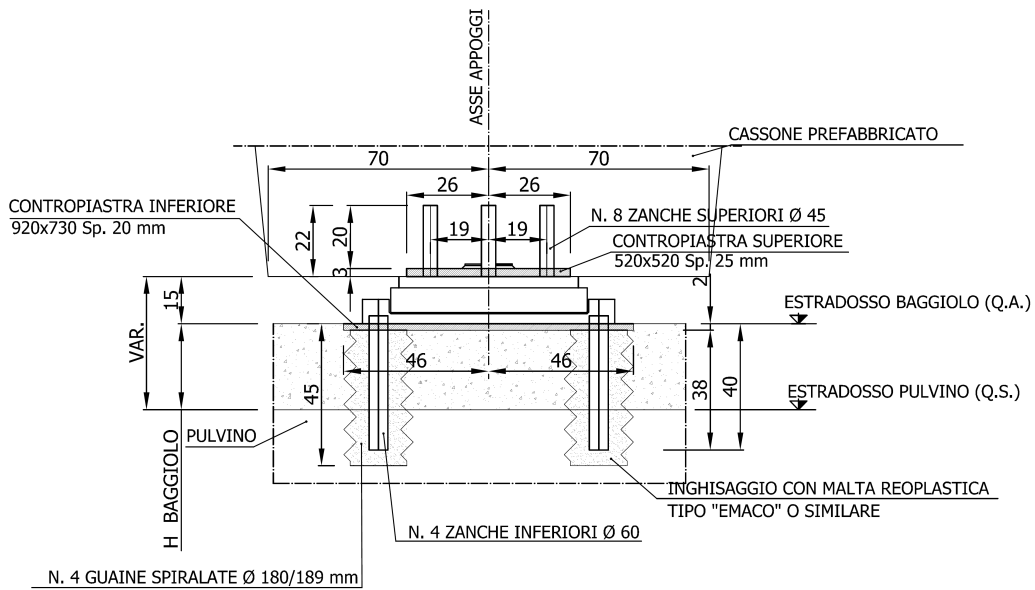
Particolare dell'appoggio unidirezionale longitudinale
